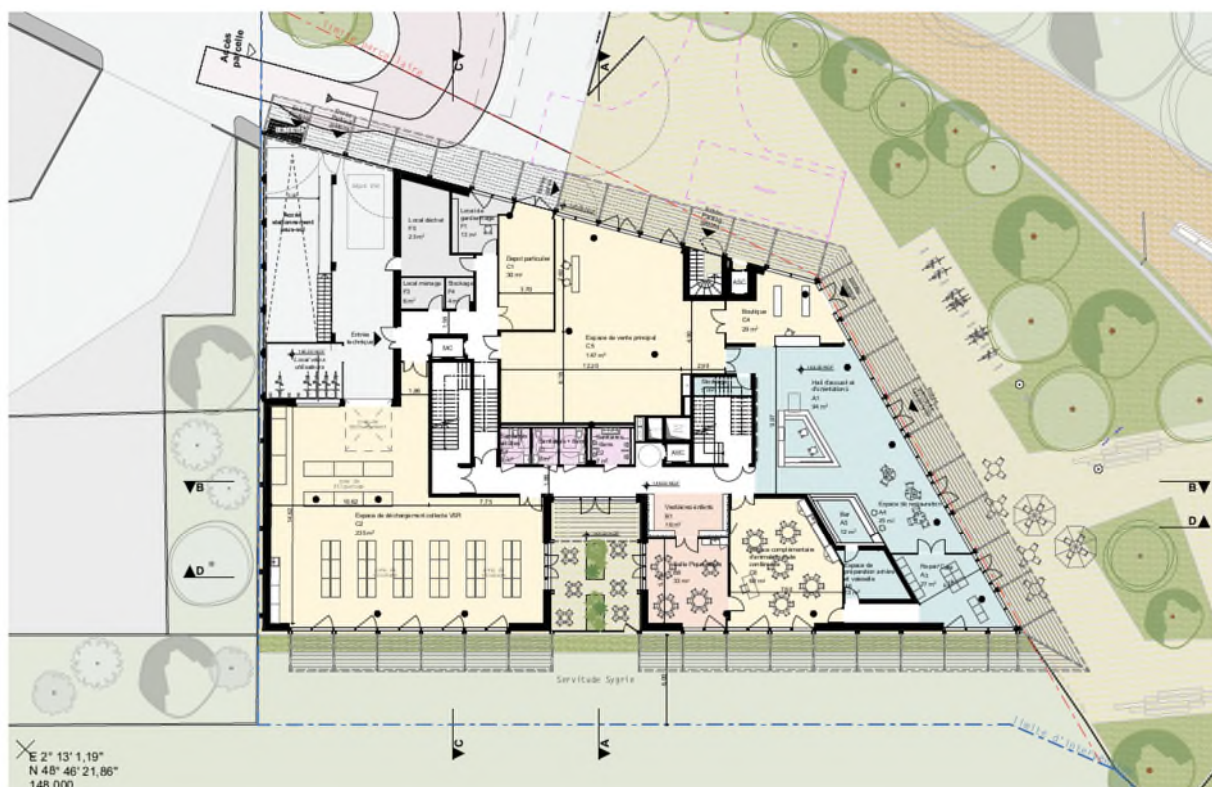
Plan masse du sous-sol – BY Bâtiment APS
